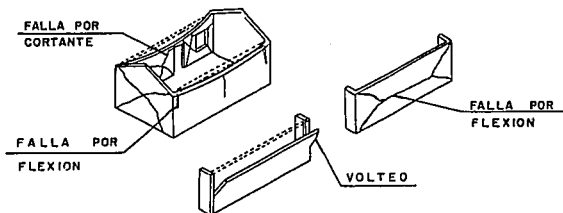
DAÑOS EN MUROS DE MAMPOSTERIA
